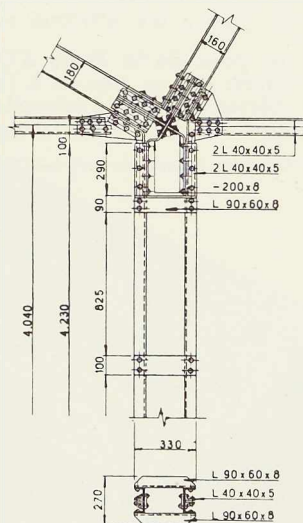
Assemblage de deux poutres principales à une colonne d'appui.
